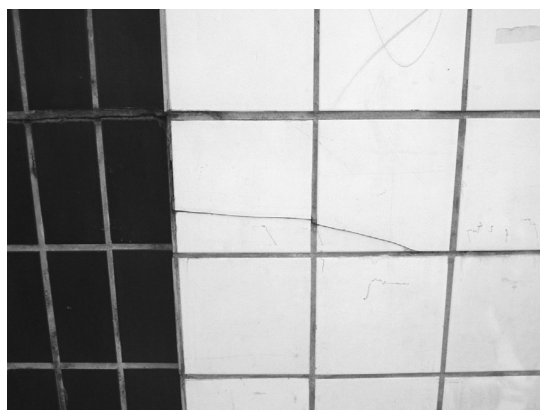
Trinca em placa cerâmica de fachada
